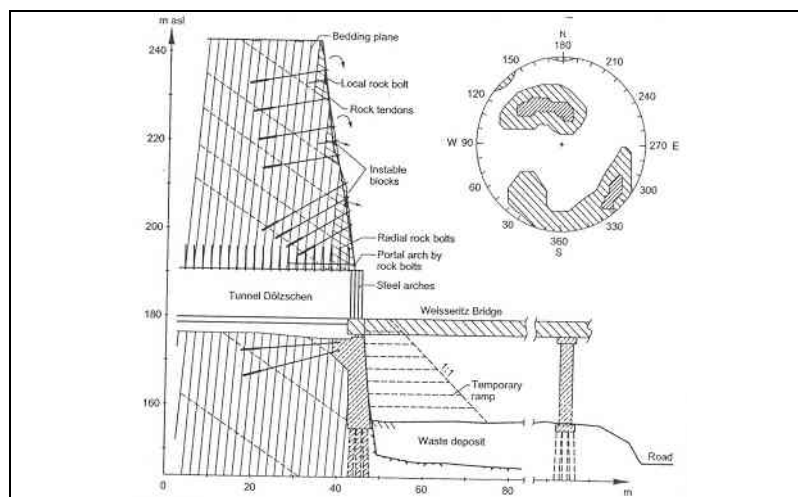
Boquilla Sur del Túnel de Dölzschen y estribo Norte del. Puente de Weißeritz.. Soluciones constructivas y diagrama con el diaclasado (Spang, 2003)
